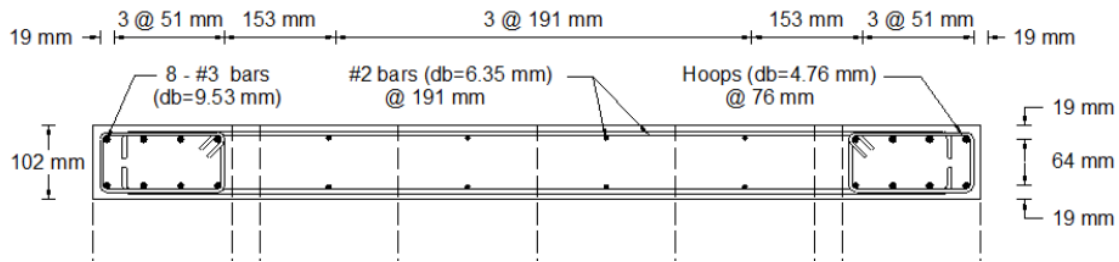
Geometría y refuerzo del espécimen RW-2.
